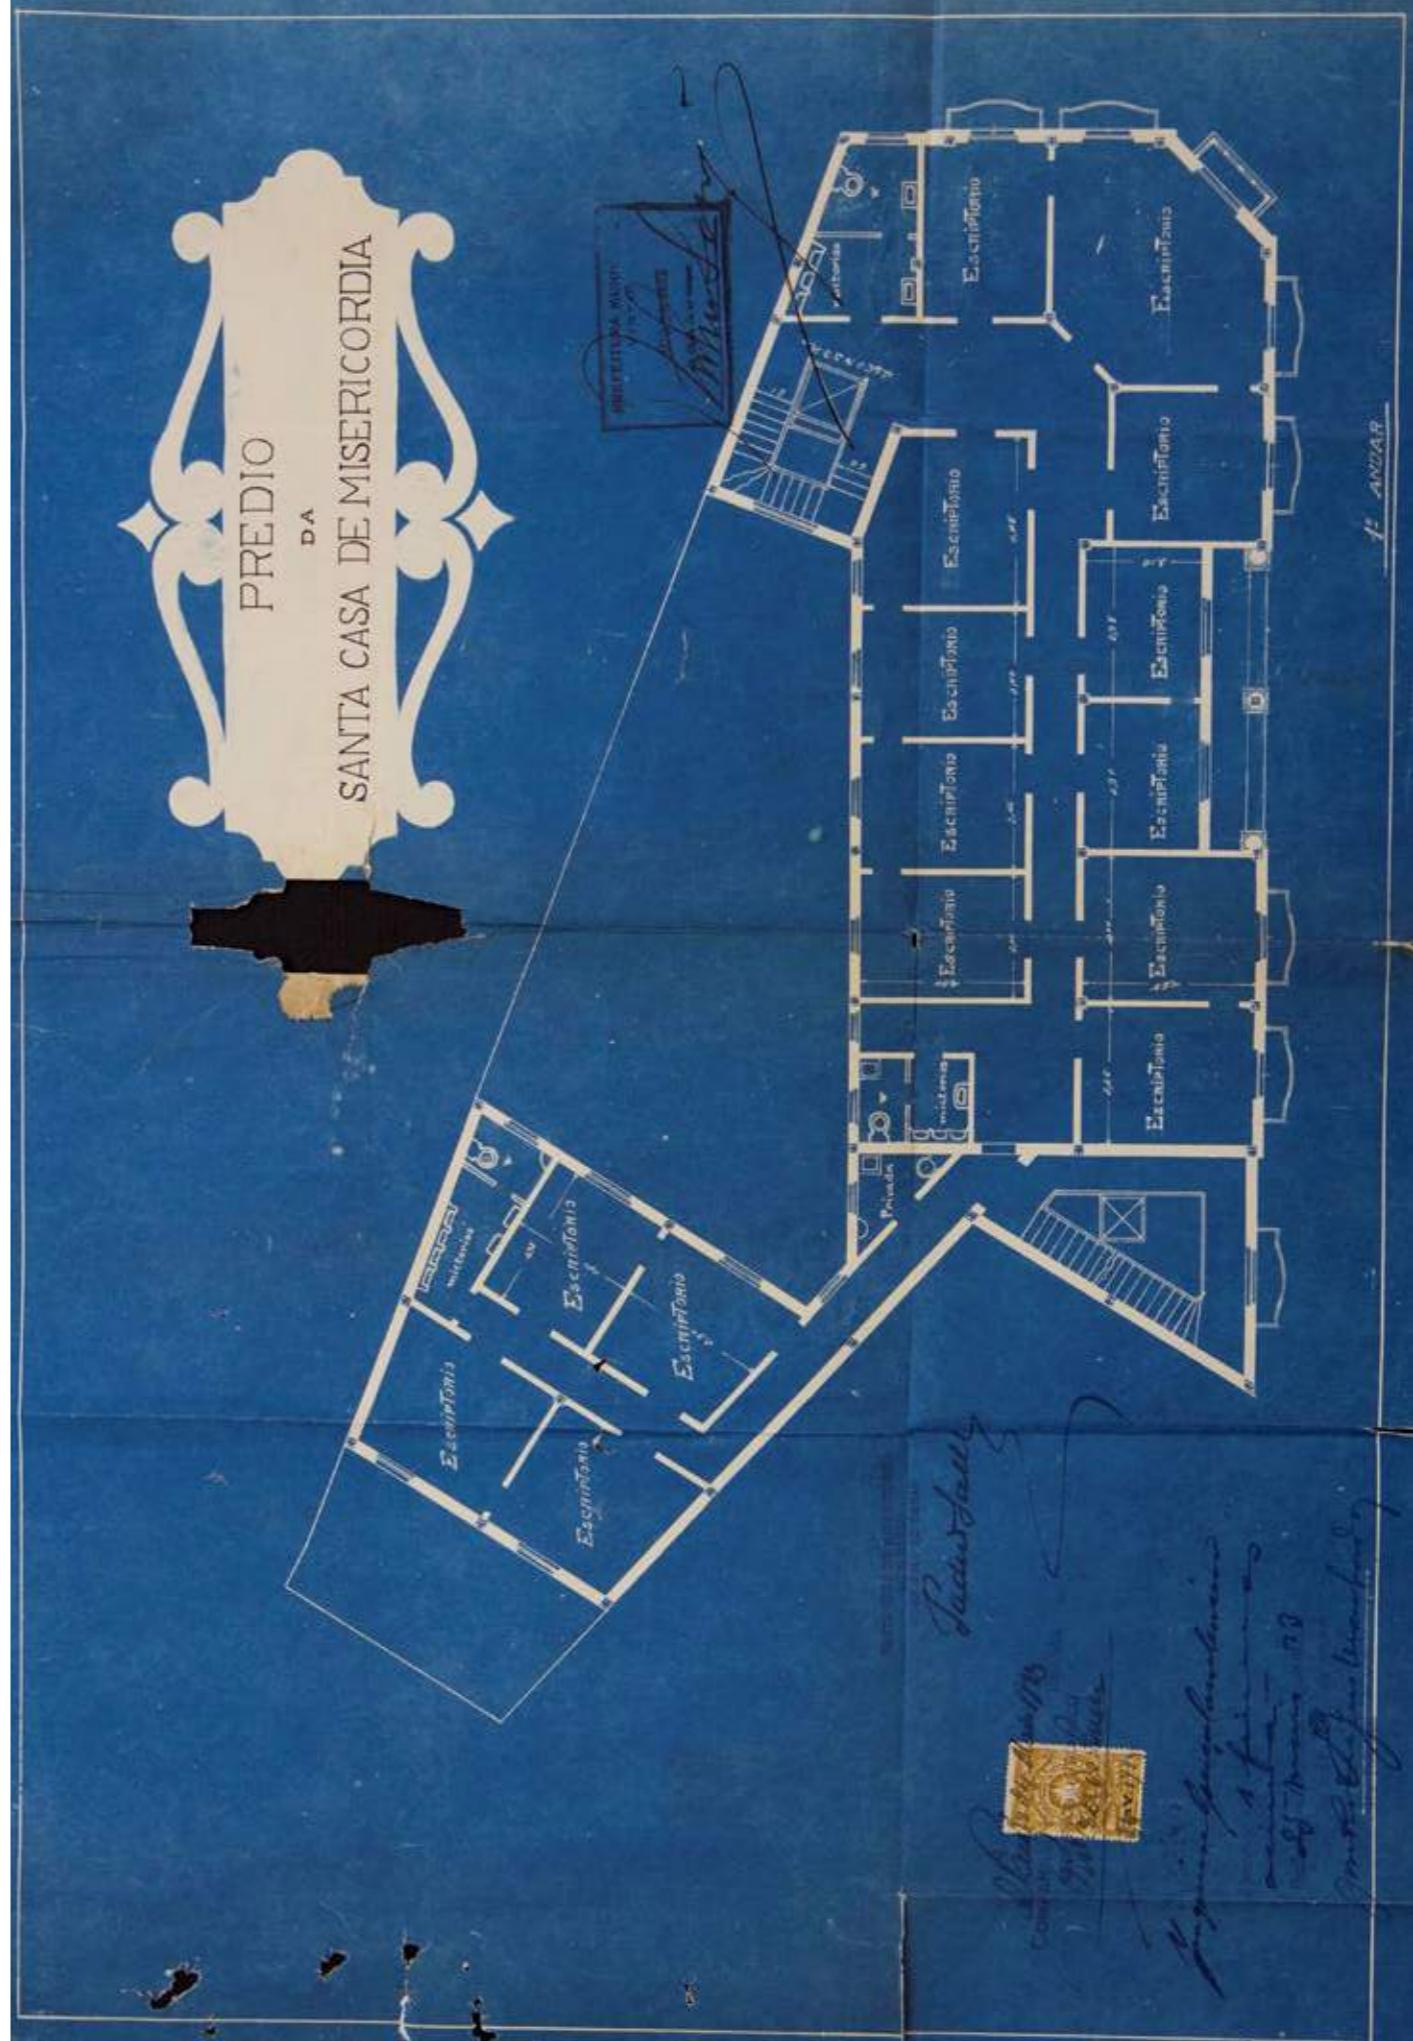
Planta do 2º pavimento (1º andar), 1923. Fonte: Arquivo Histórico de São Paulo.
